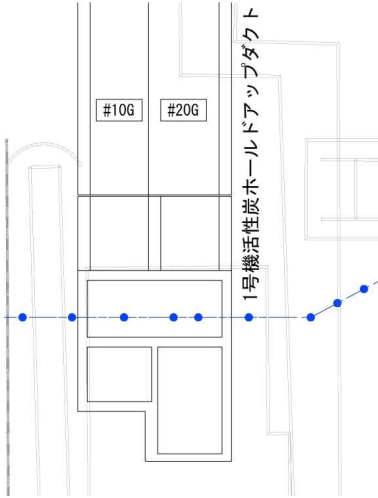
【5-2】2号機主変圧器ケーブルダクト 施工方法（貫通施工）
